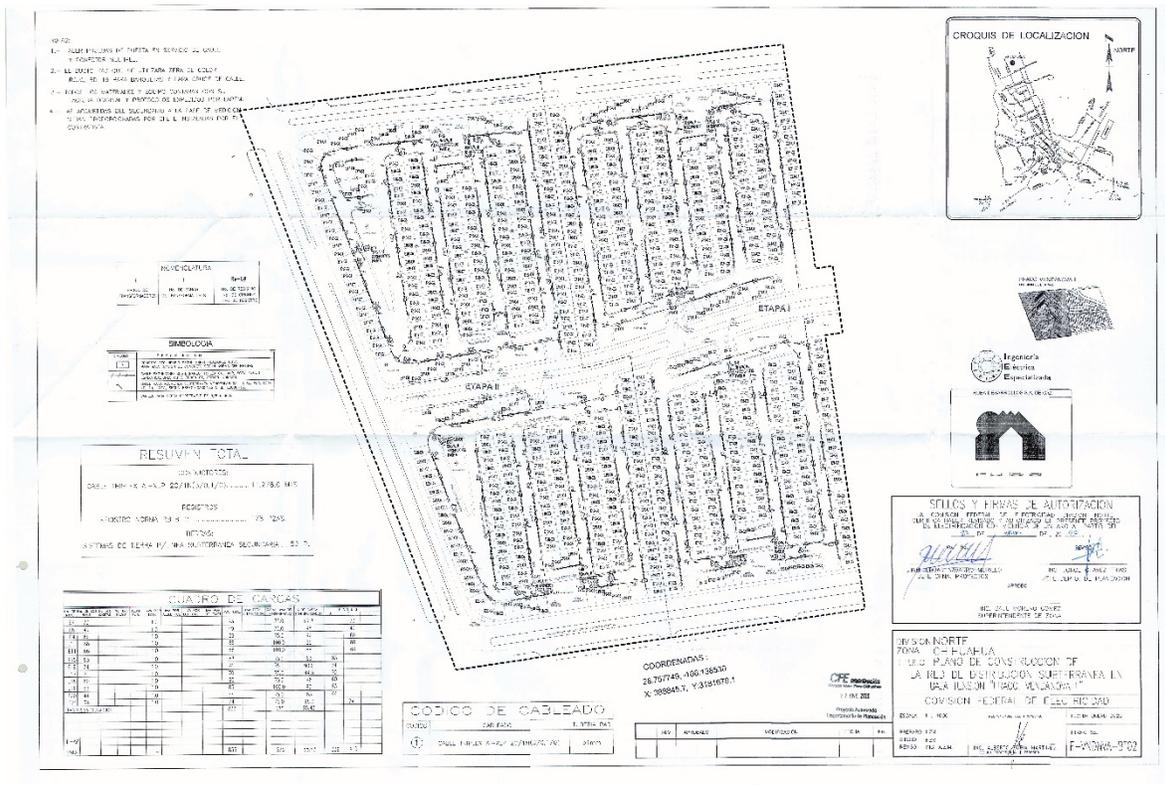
Plano de Baja Tensión de la etapa II de Vendanova II. Fuente: Proyecto de Baja Tensión autorizado por la Comisión Federal de Electricidad realizado por Ingeniería Eléctrica Especializada para el fraccionamiento Vendanova II.
